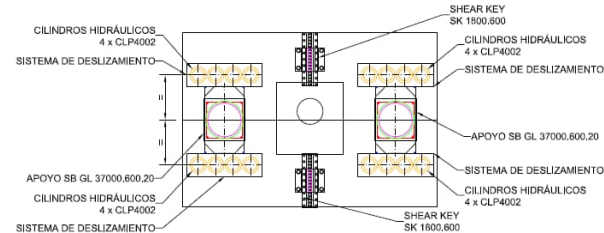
Esquema de la posición de dispositivos y equipos de la solución proyectada.
